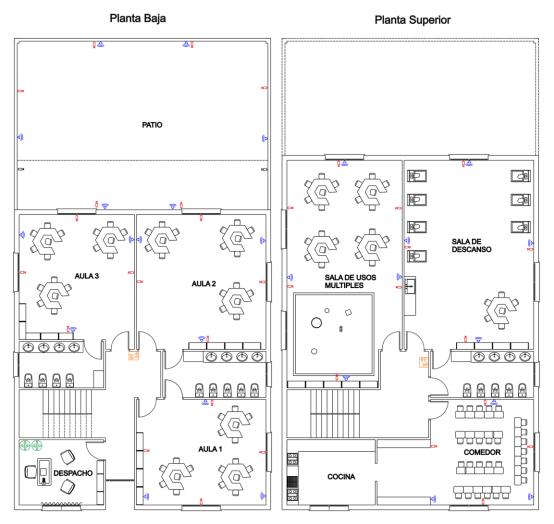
Plano de Centro Infantil ficticio con la instalación de Locaviewer
